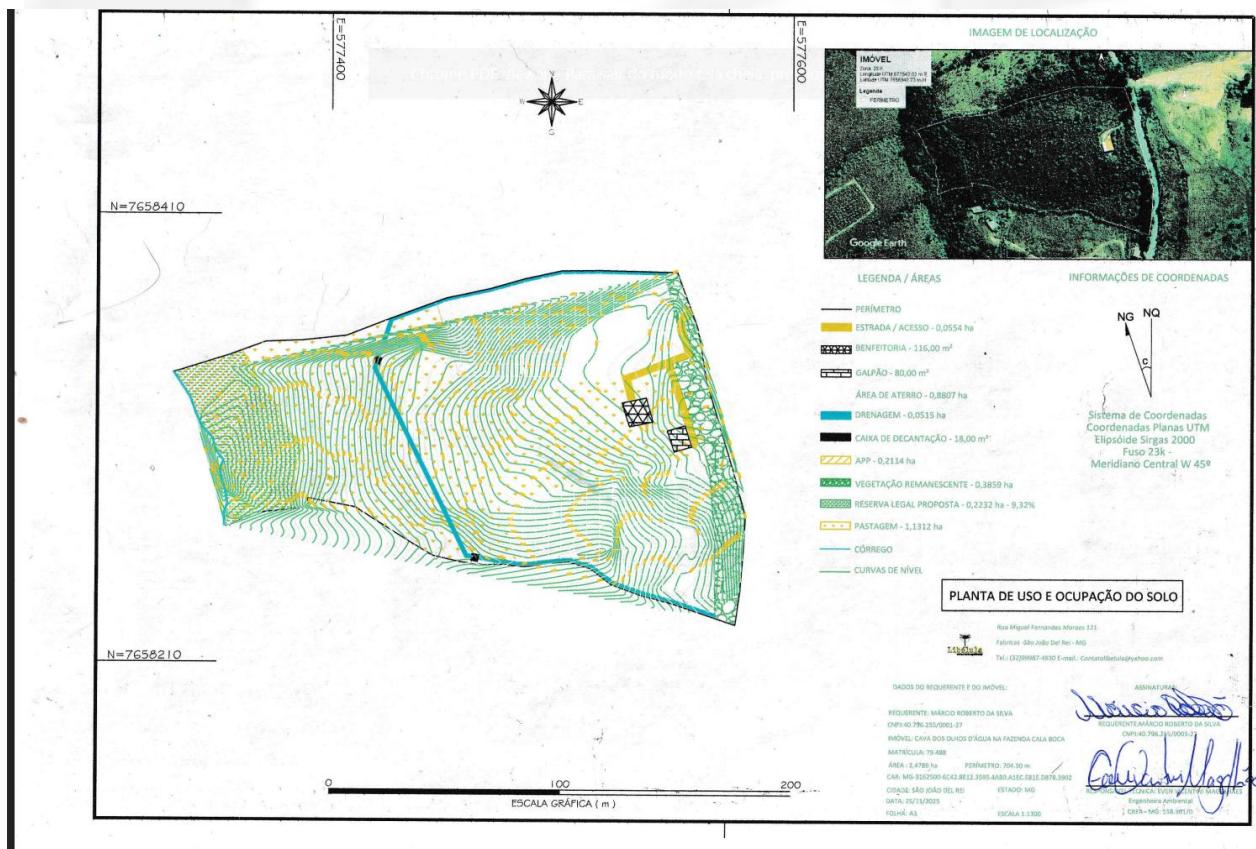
Layout do empreendimento em planta. Fonte: processo administrativo.
